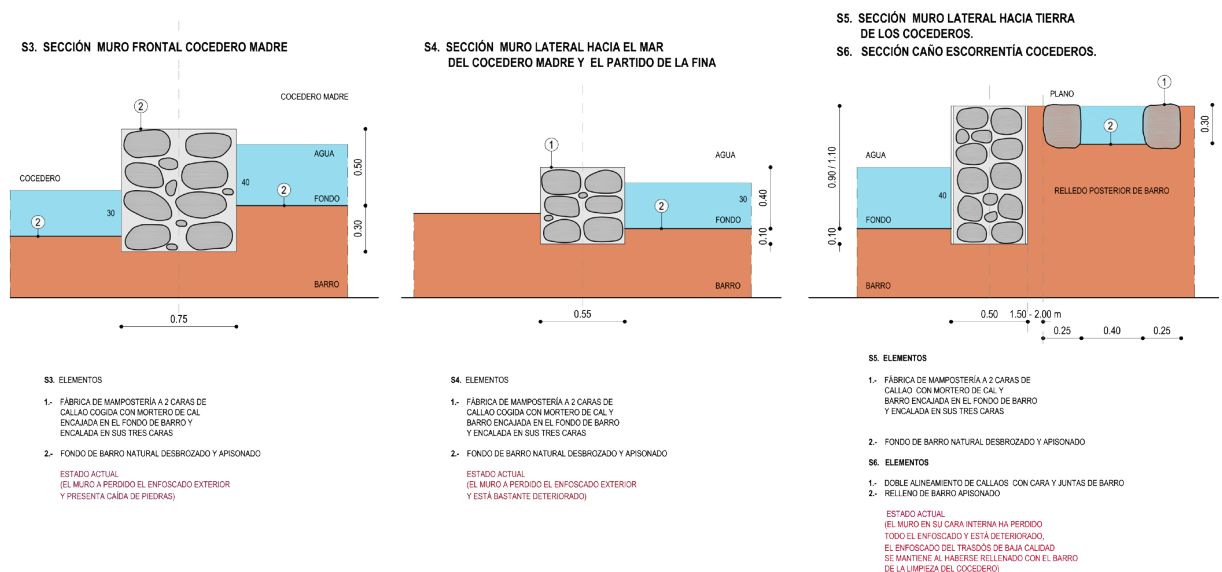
Secciones de muros. Fuente: Proyecto de ejecución restauración paisajística de las Salinas del Río [4].
